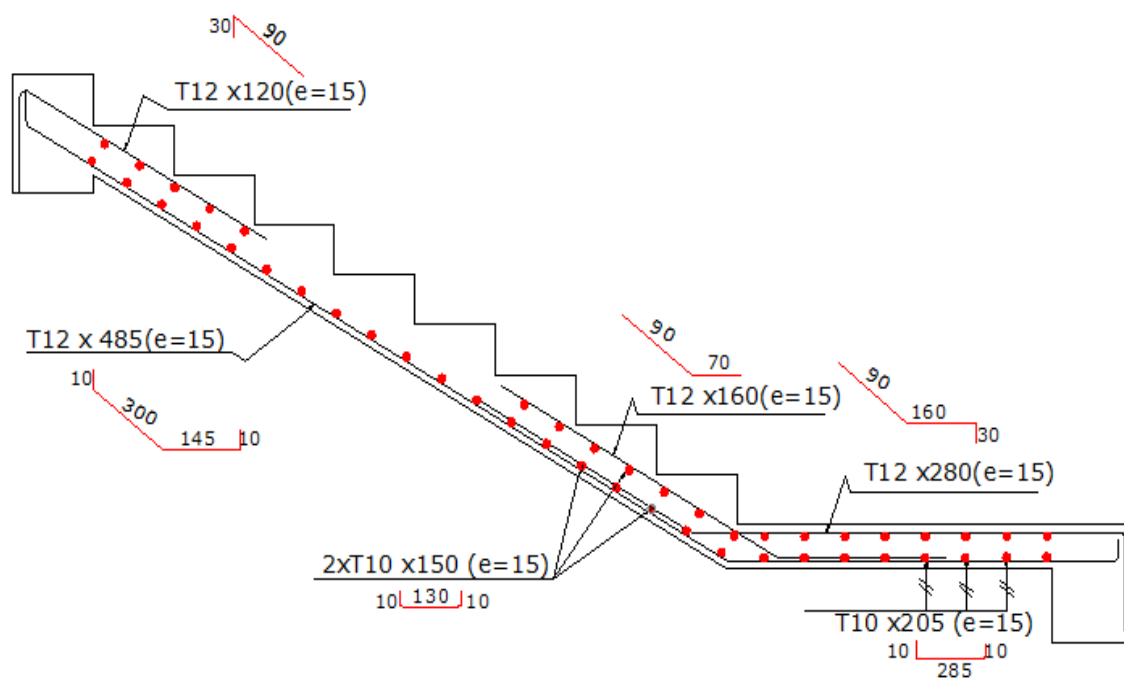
Schéma de ferrailage de la 1^{ère} volée de l'escalier de RDC
